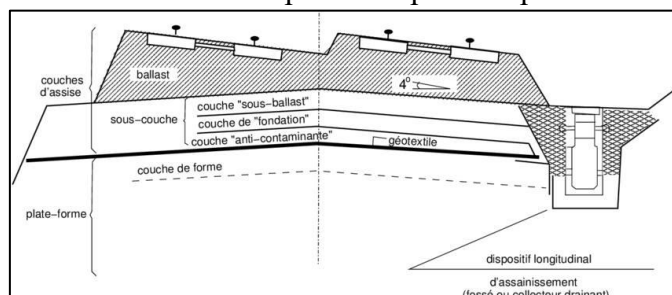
Raccourci d'un profil en travers expliquant les couches de voie ferrée
